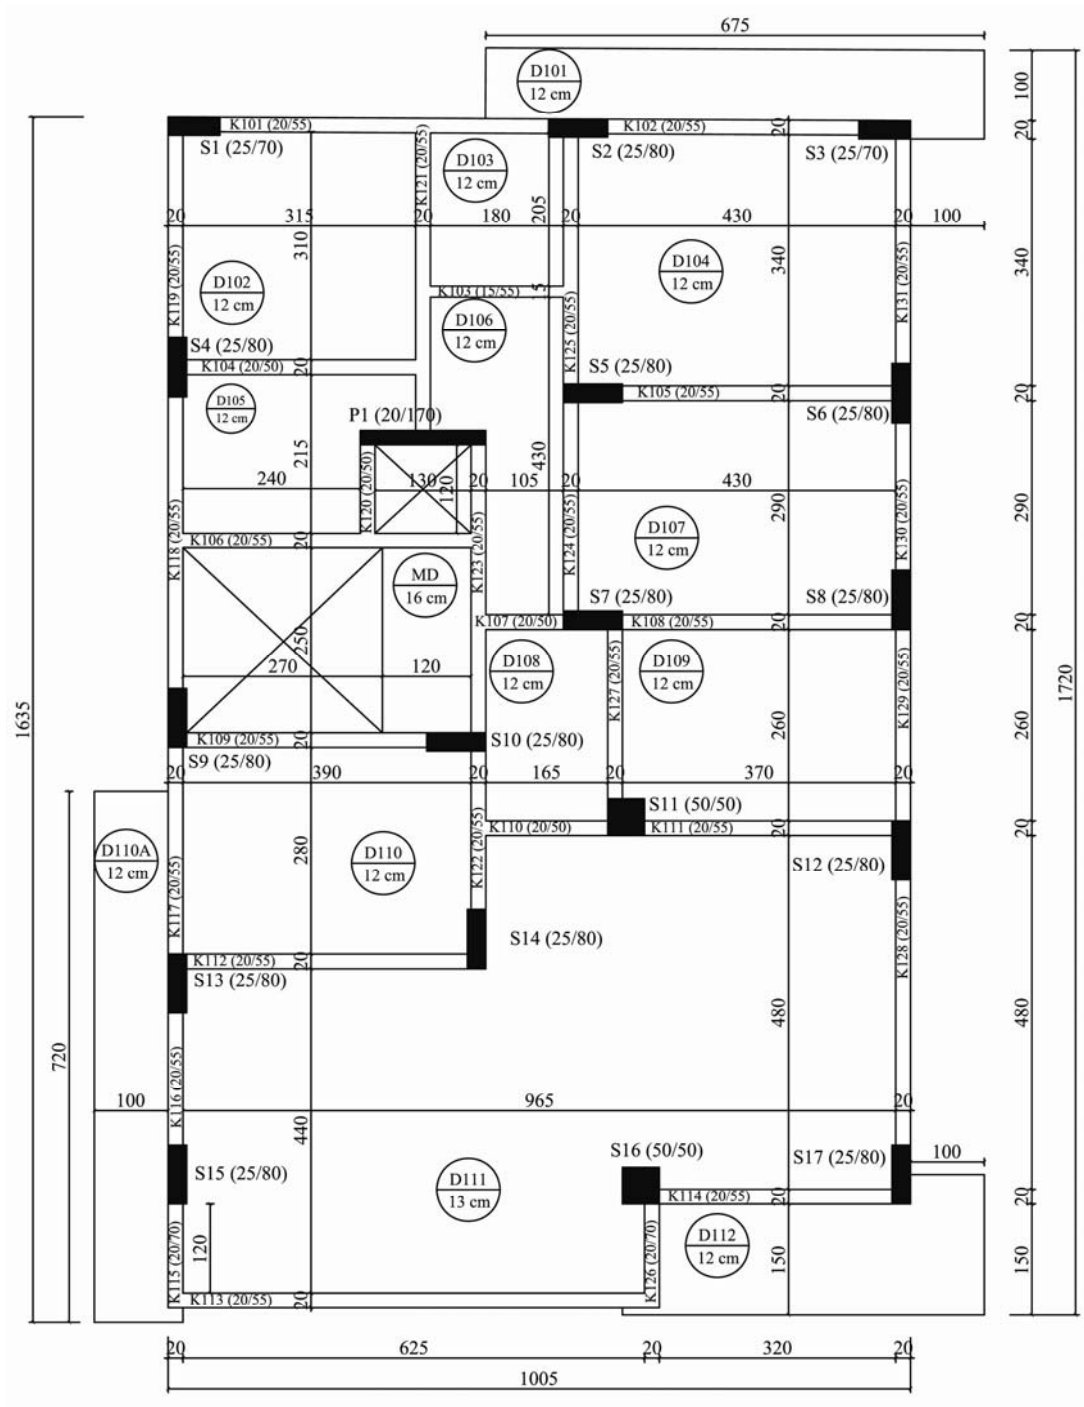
B6\_5'in kat kalıp planı
